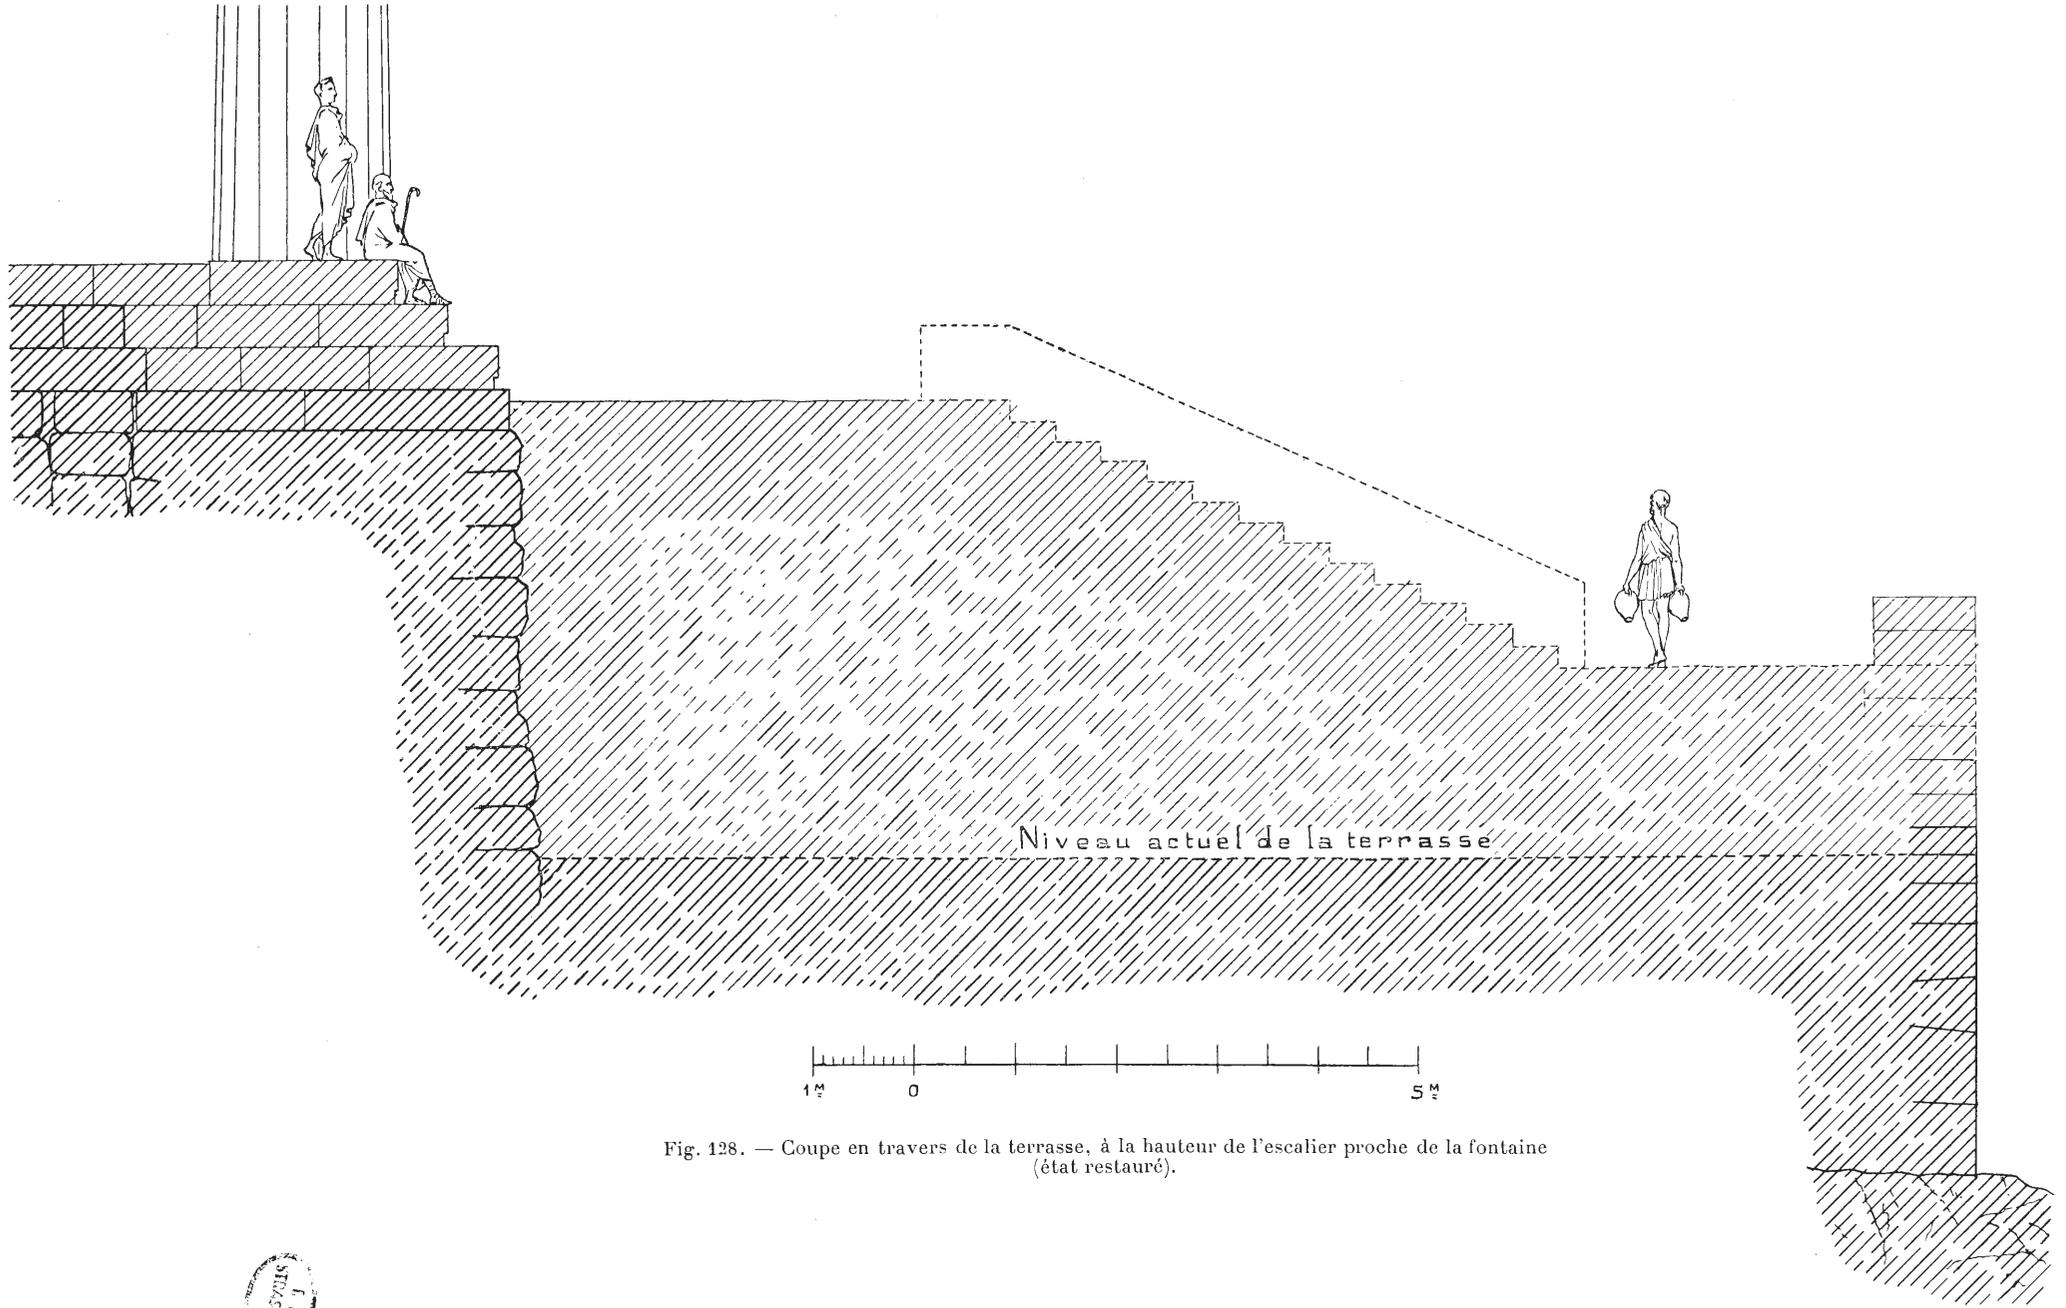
Coupe en travers de la terrasse, à la hauteur de l'escalier proche de la fontaine (état restauré).
